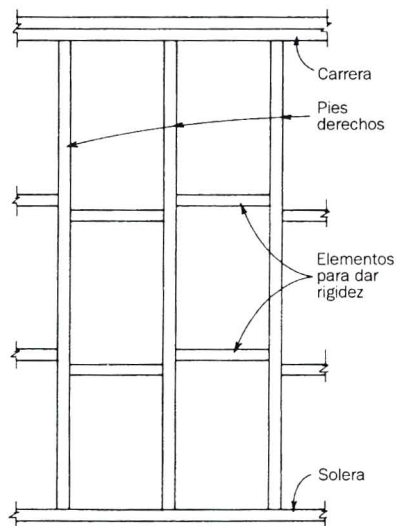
Construcción a base de pies derechos, con elementos para darles rigidez.
